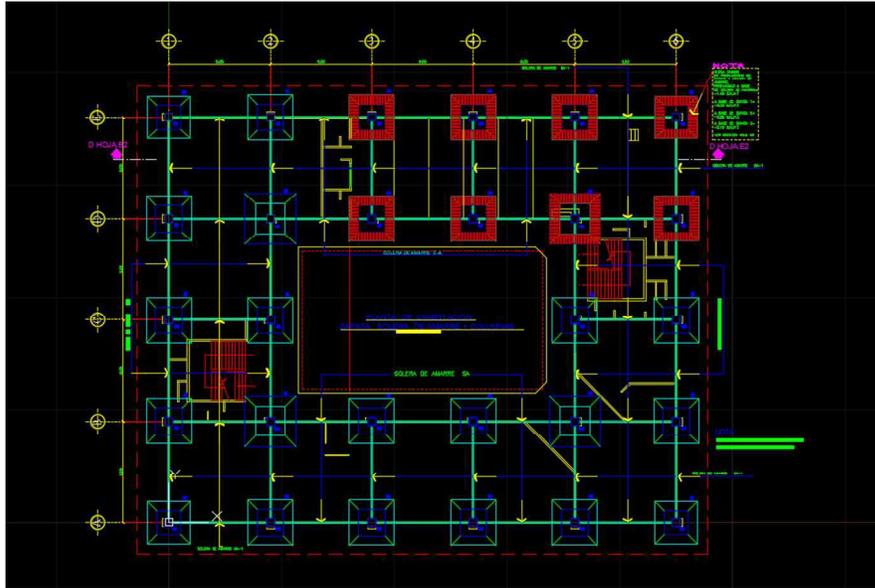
Ubicación de planta de cimentación en coordenadas (0,0) en un nuevo archivo de AutoCAD
